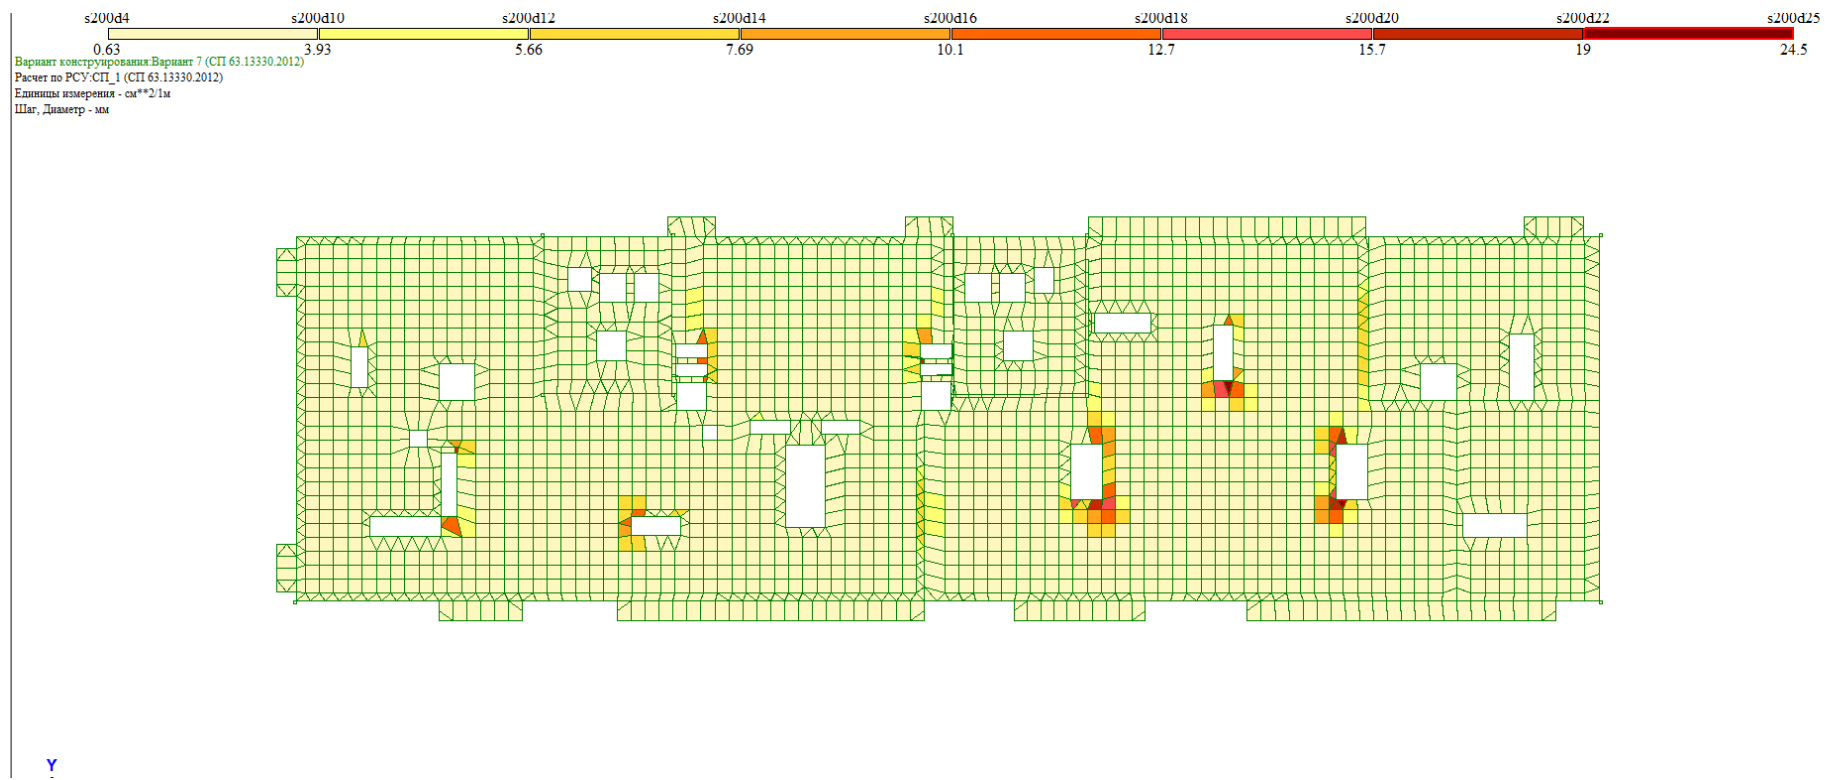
Площадь арматуры на 1 пм по оси X у верхней грани плиты покрытия
